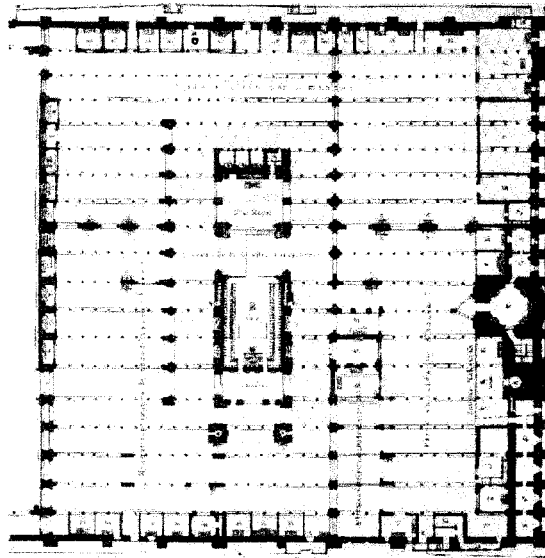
Planta de la mezquita-catedral de 1879 según López Sánchez y Pérez Barquero.
